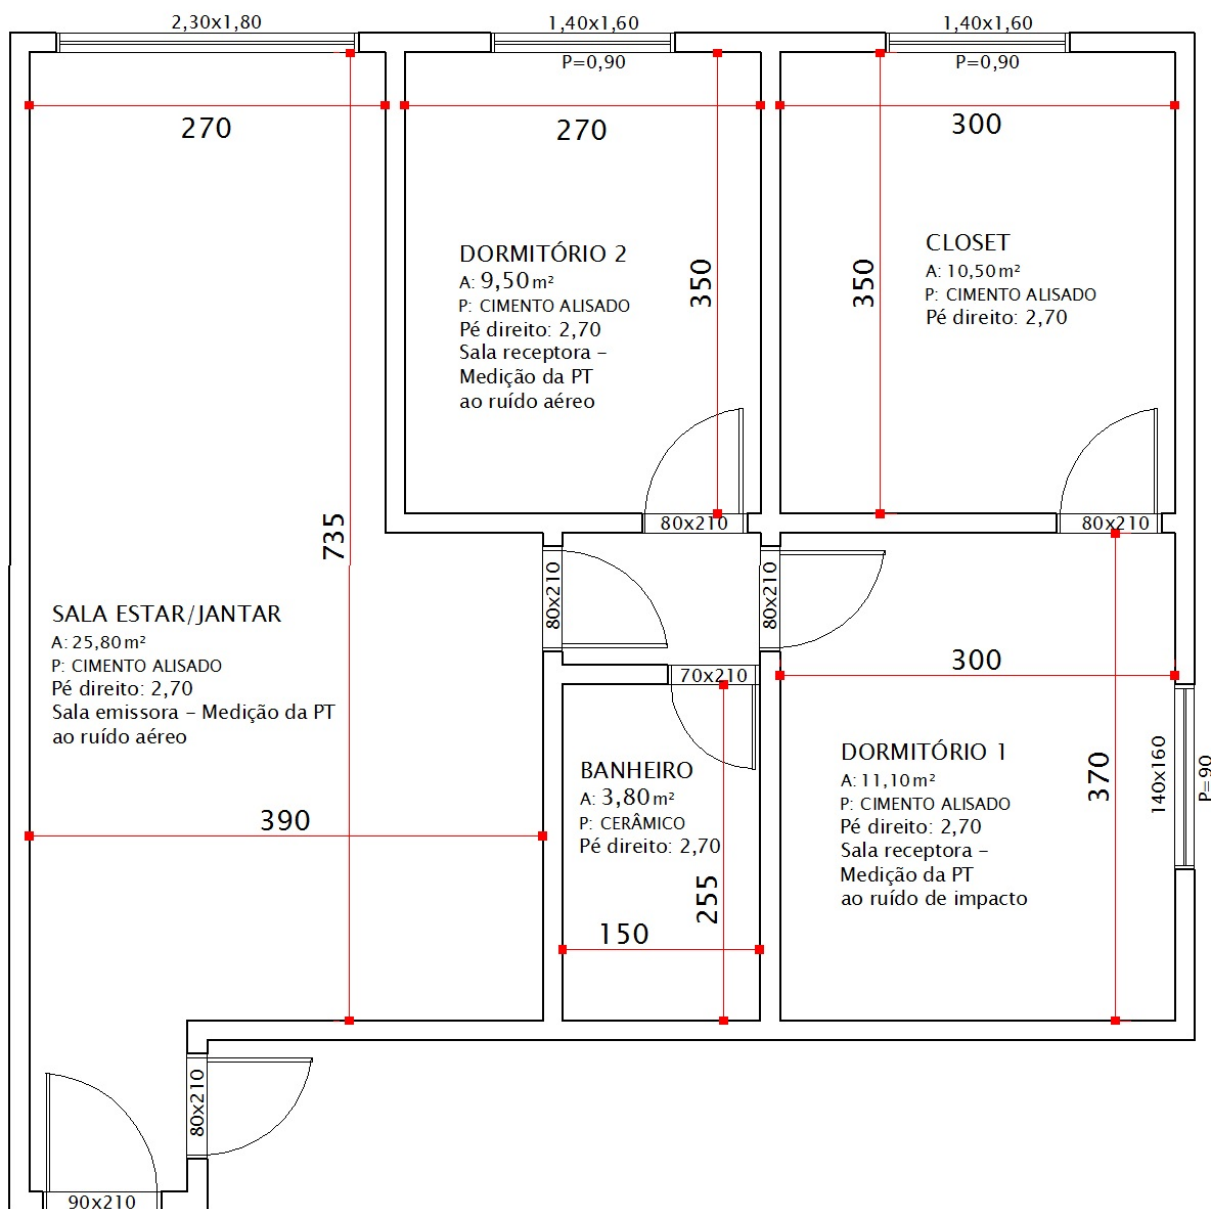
Planta baixa - pavimento inferior - 05-R8-N-TV
